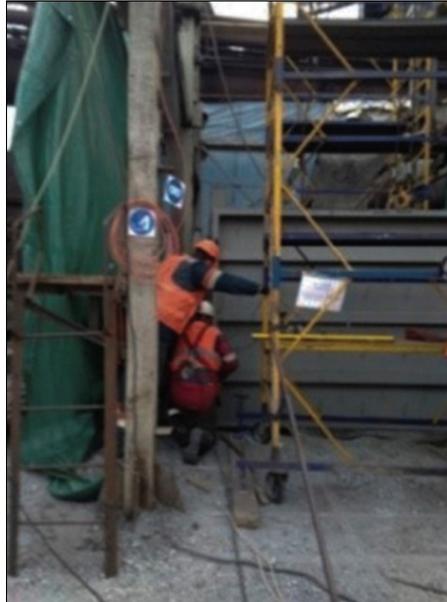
Укрупнительная сборка монтажного блока стенок корпуса фильтра.
